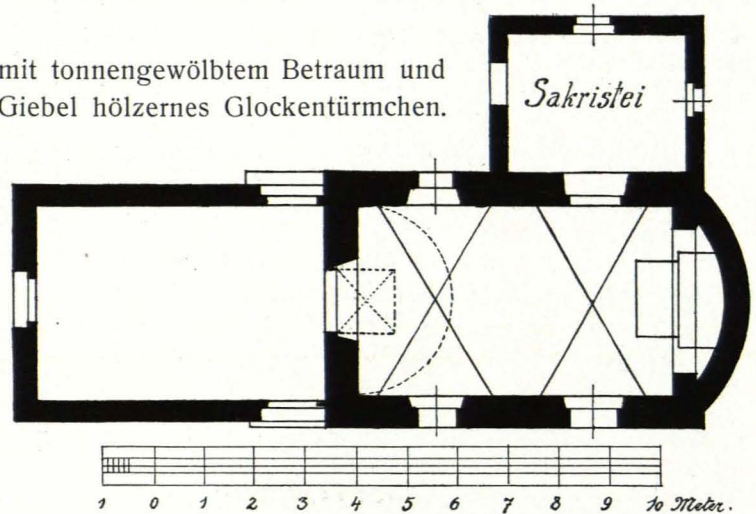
Viehhausen. Kapelle, Grundriß 1 : 150 (S. 472)
